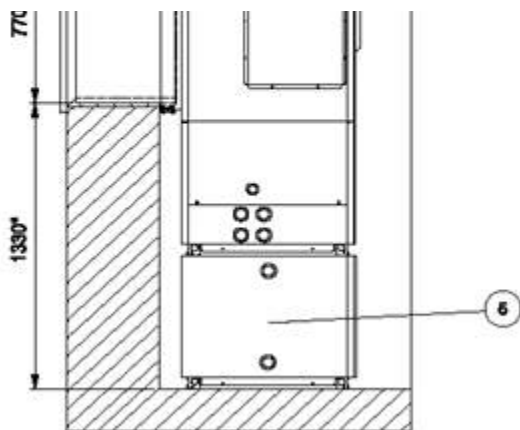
Instalacja ze zbiornikiem poniej - widok z boku
